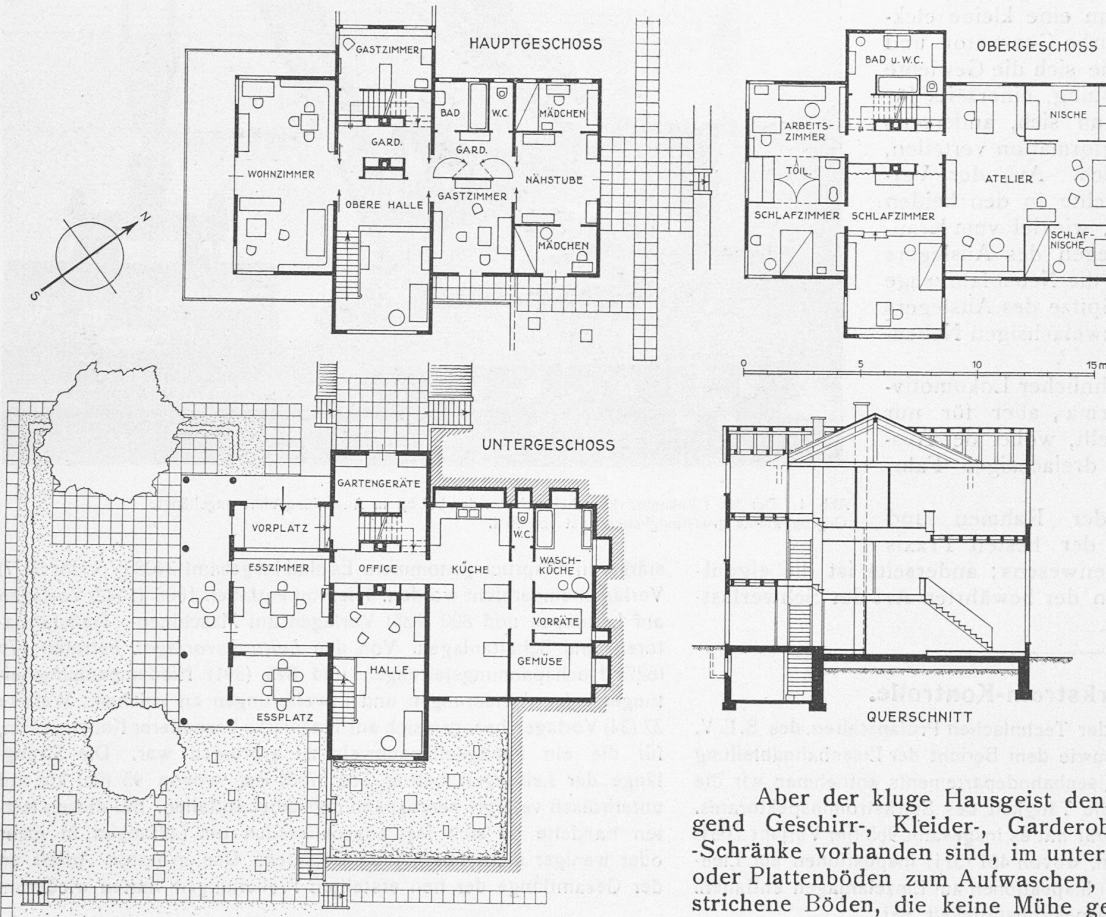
Eigenheim der Architektin Lux Guyer in Itschnach. Grundriss und Querschnitt. — Masstab 1 : 800.
